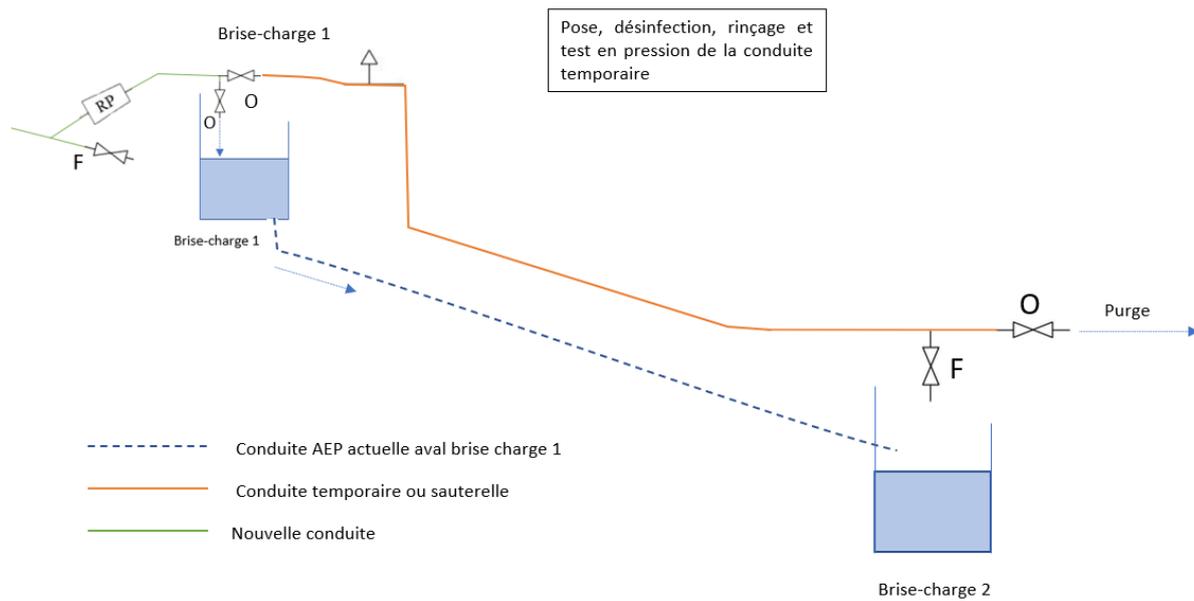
Mise en place de la conduite temporaire entre brises-charge
